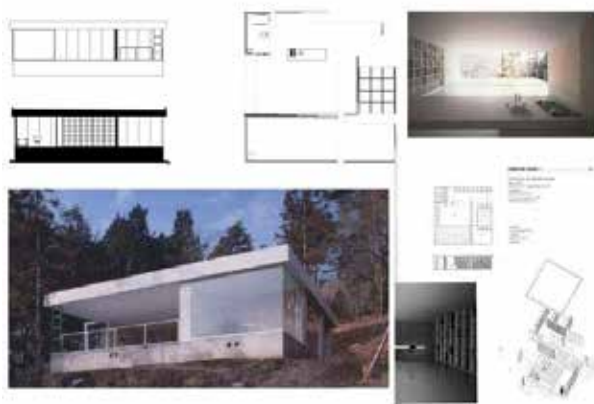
家具の家 外観・内観写真、断面・平面図、立体構成図
